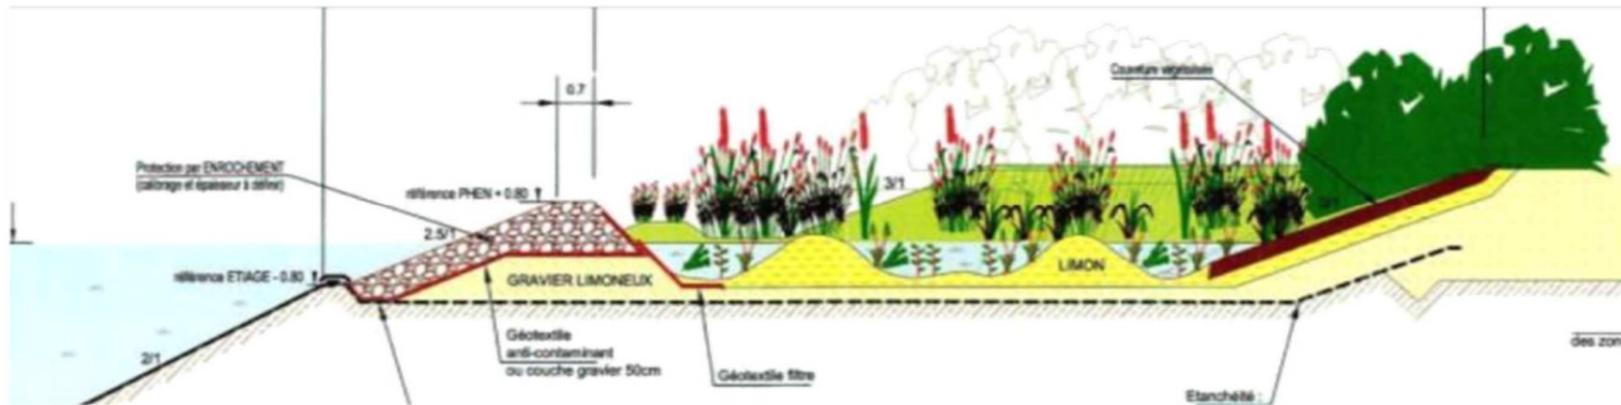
Coupe transversale type d'une berge lagunée (source : CNR)
